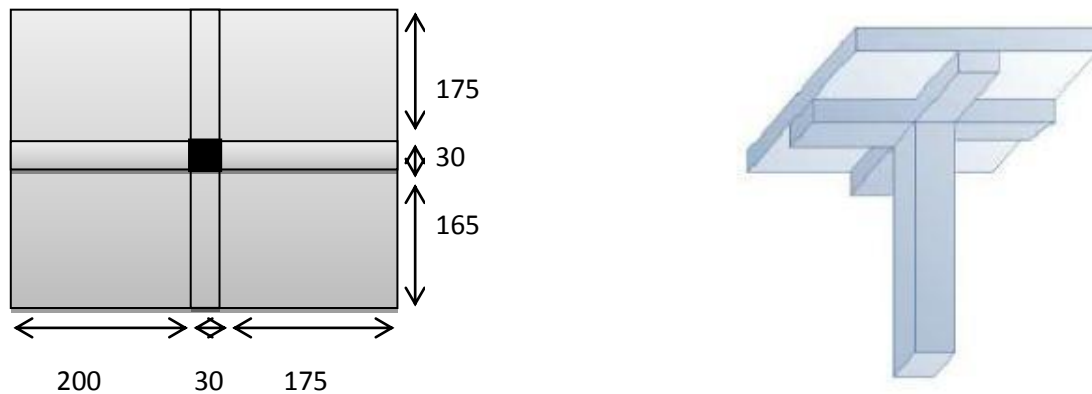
Dimension de la section revenant au poteau le plus sollicité
